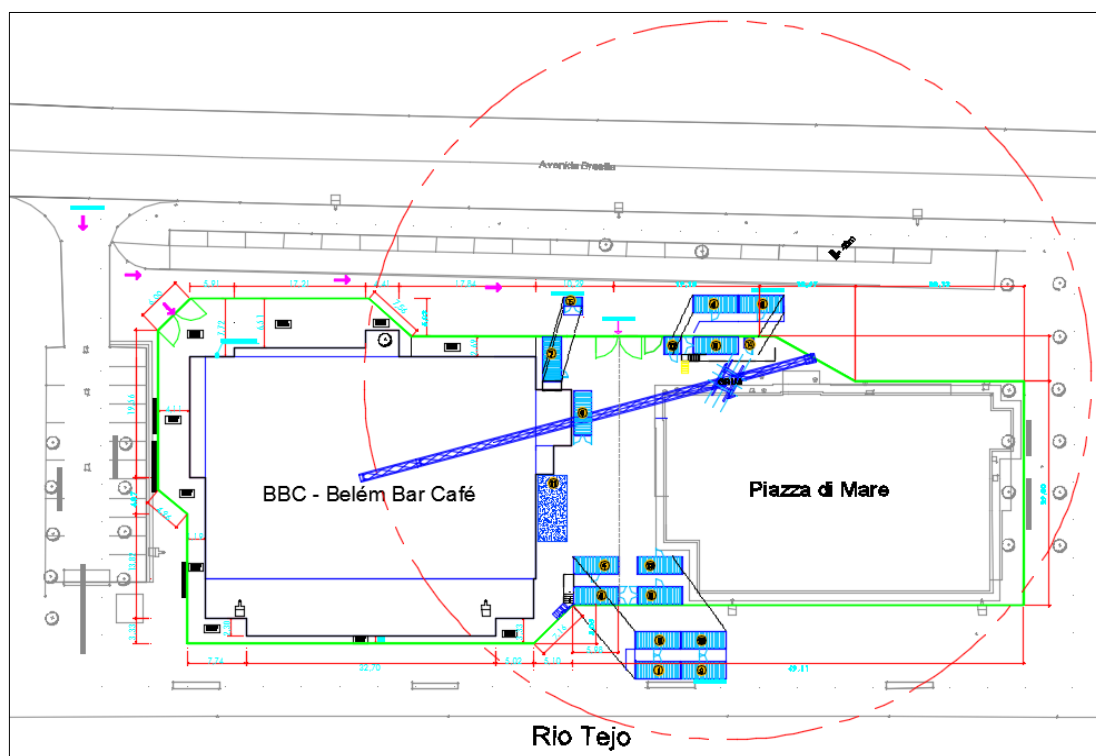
Planta de Estaleiro com a Grua Torre implantada
